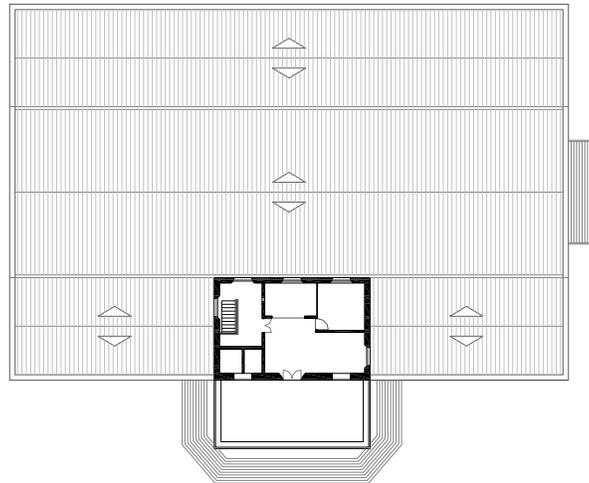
Planta Baixa do 1º pavimento - situação atual da edificação; sem escala
